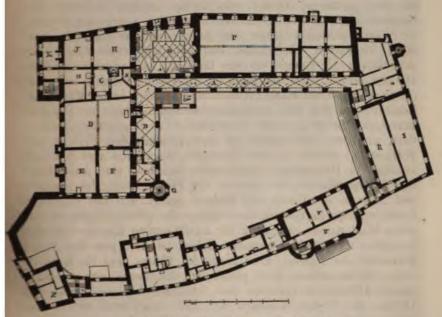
Trausnitz. Grundriss des ersten Stockes.
